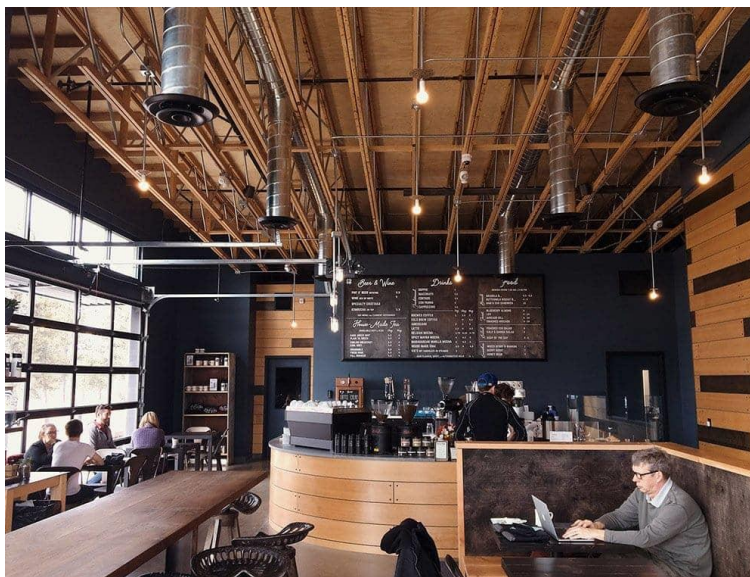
แสดงโครงข้อหมุนไม้-เหล็ก(Open steel web wood truss)
